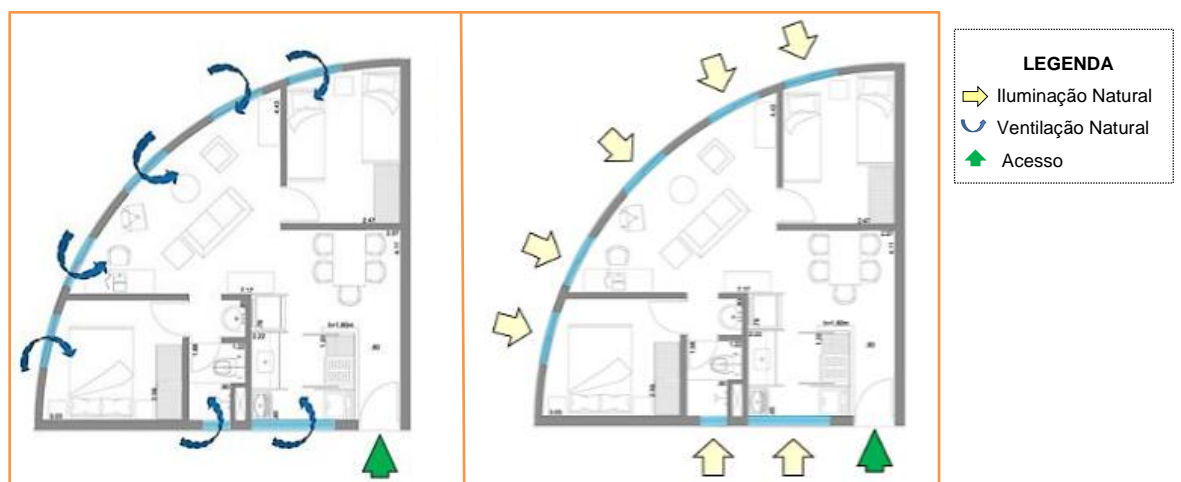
Planta tipo das unidades do conjunto residencial Redondinhos.
